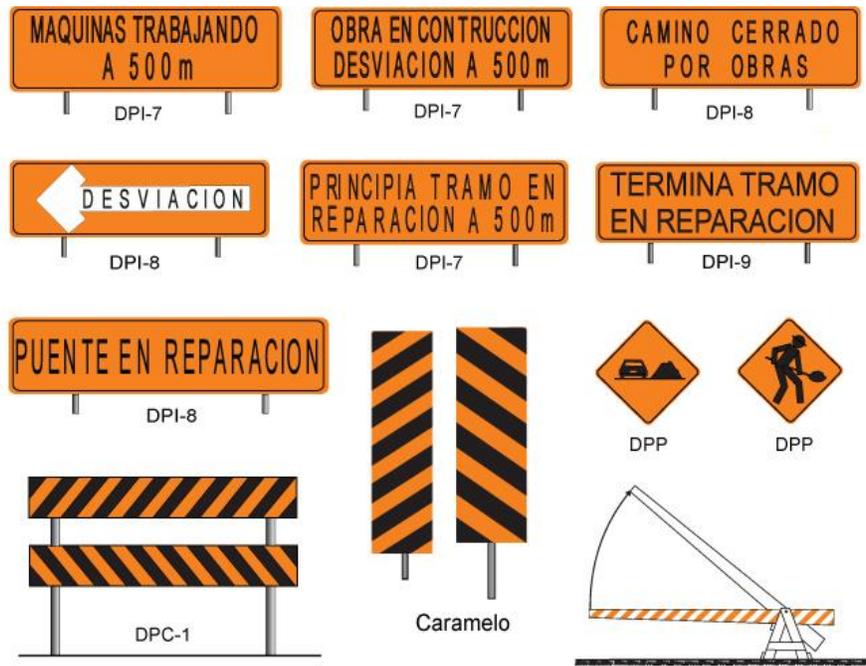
Dispositivos para protección de obras (DP)
